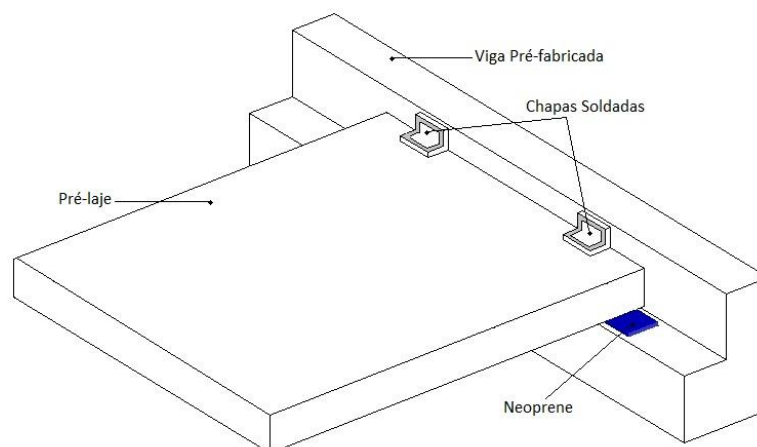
Ligação Laje – Viga de extremidade com chapas soldadas
